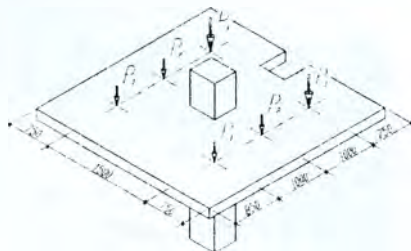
Схема эквивалентных нагрузок на плиту НП – 7
